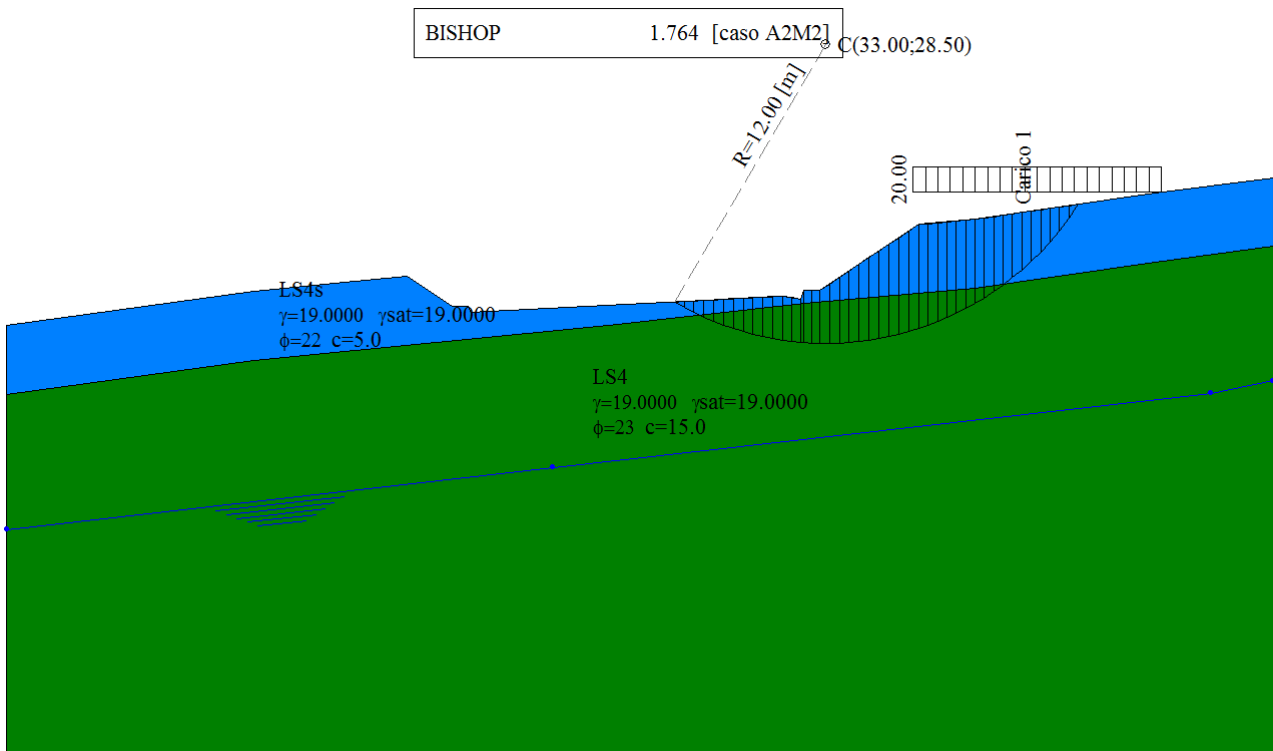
Verifica di stabilità globale - condizione statica drenata
